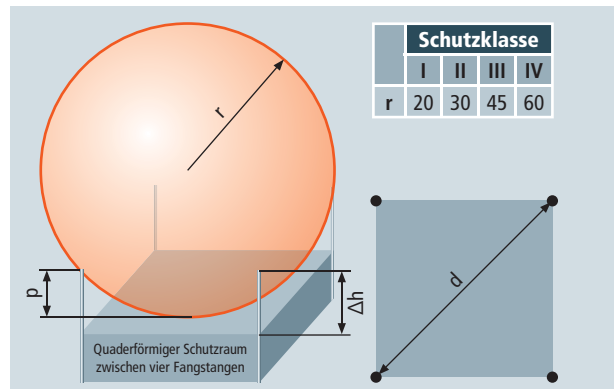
Fangeinrichtung für Dachaufbauten mit ihrem Schutzraum
